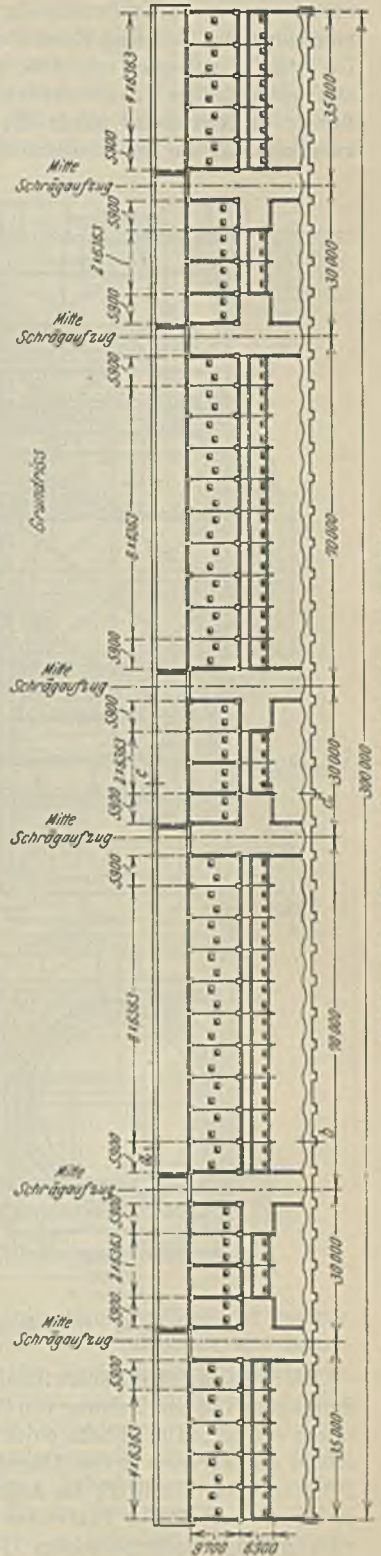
Koks- und Erzaschenanlage (Grundriss).
